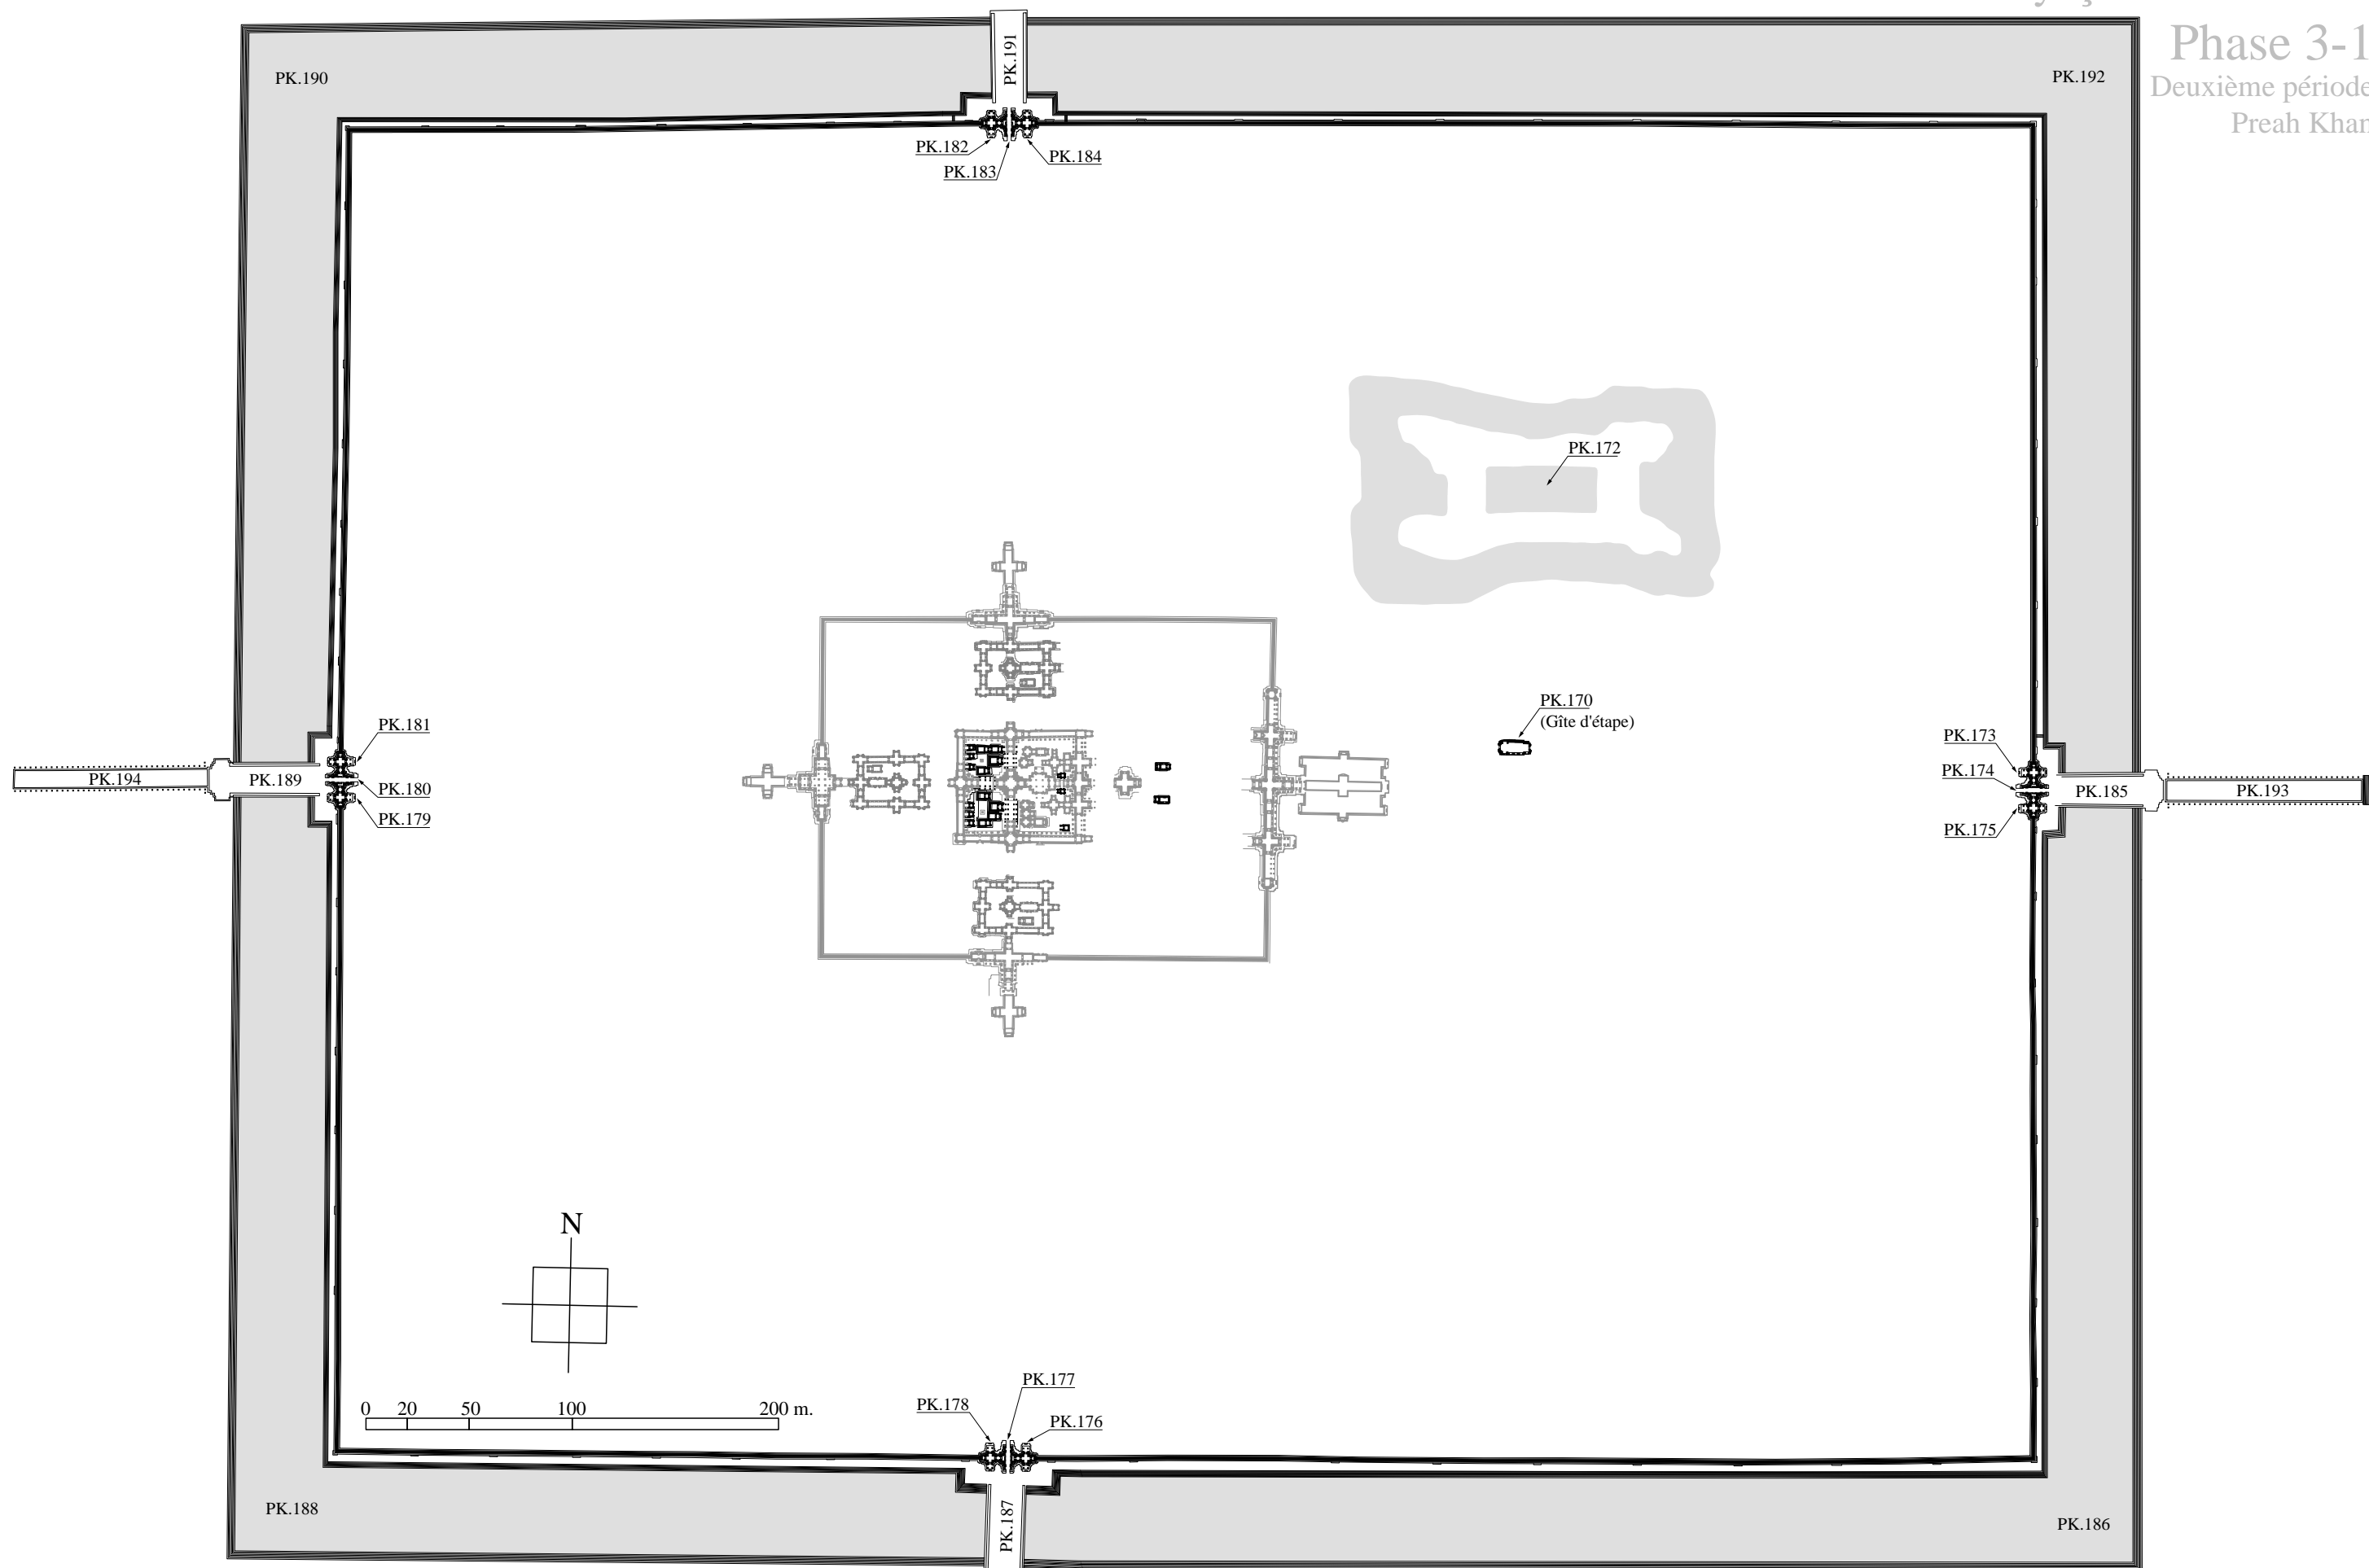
Premier état de la troisième tranche des travaux de Jayaçrī (Preah Khan d'Angkor)
